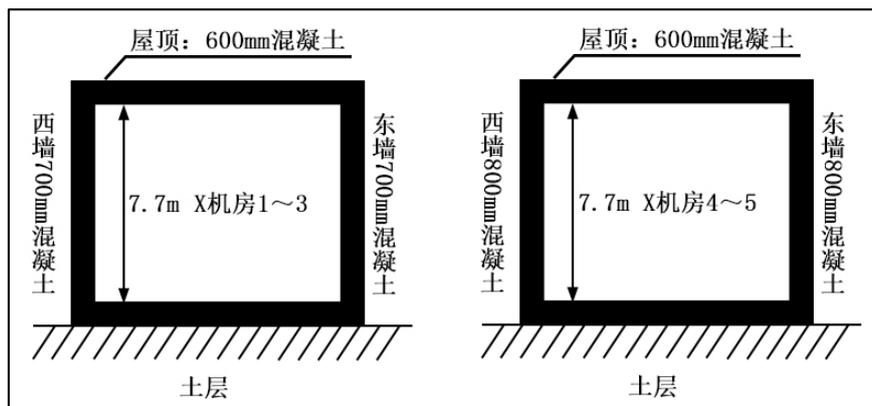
X 机房 1~5 屏蔽设计示意图-剖面图
